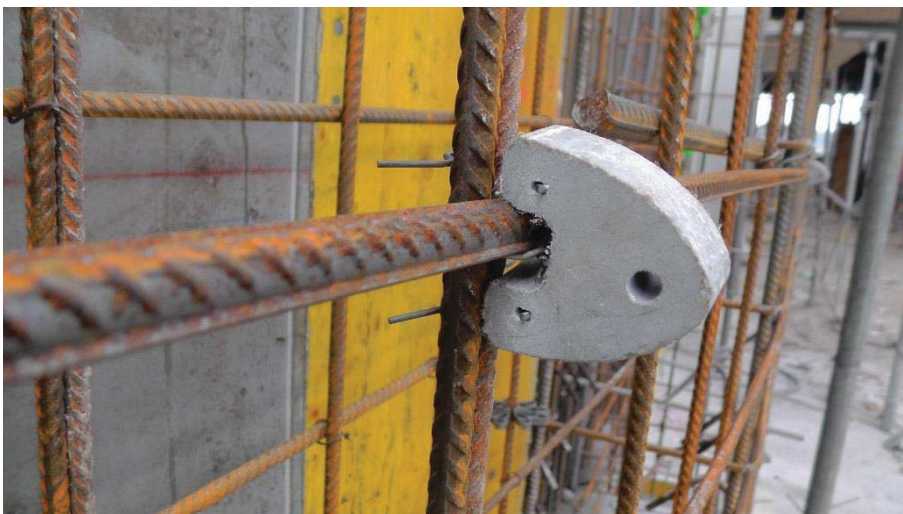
Faserzementabstandhalter für Sichtbeton
